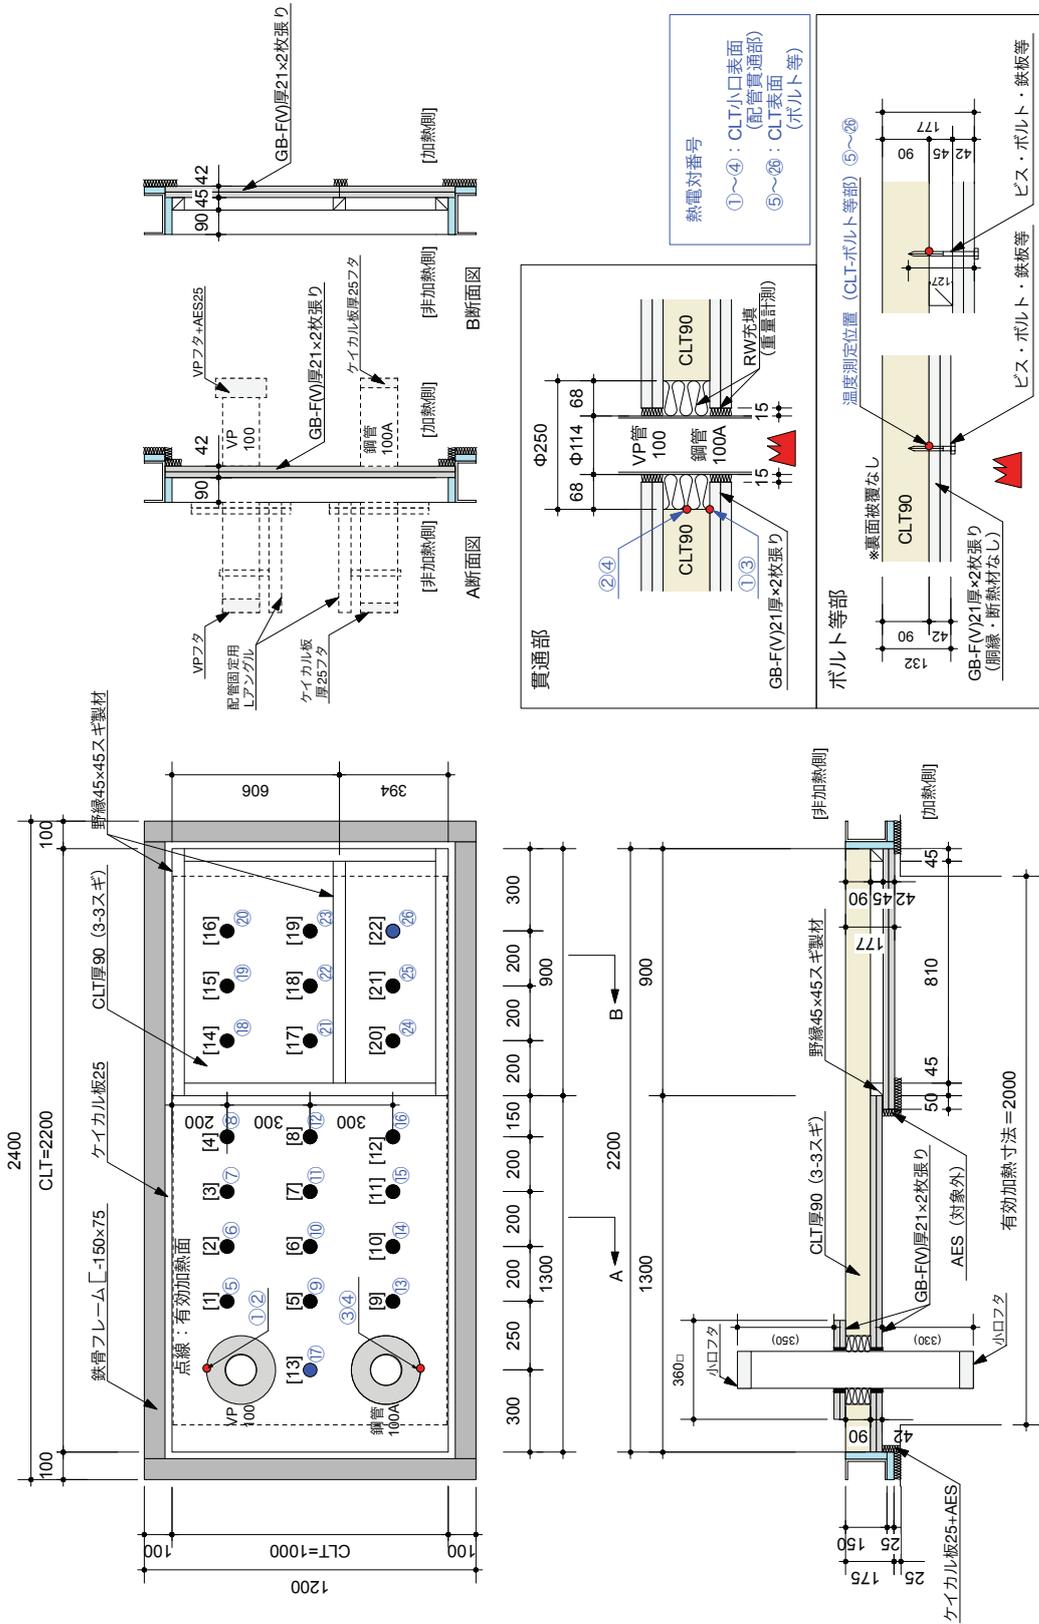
試験体 3 の熱電対位置 (単位 : mm)
